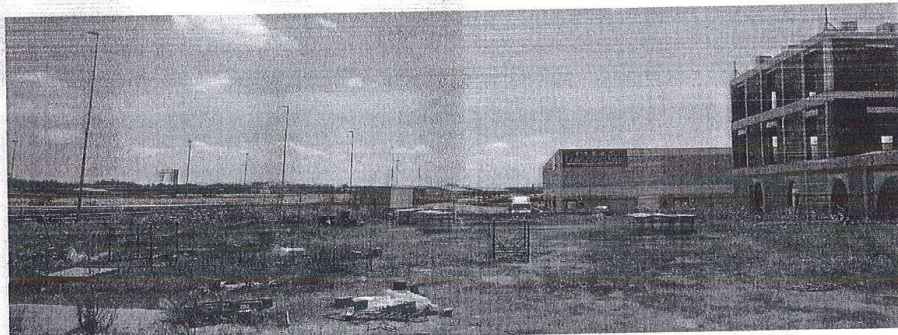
Vista dell'area libera corrispondente al mappale 5096
